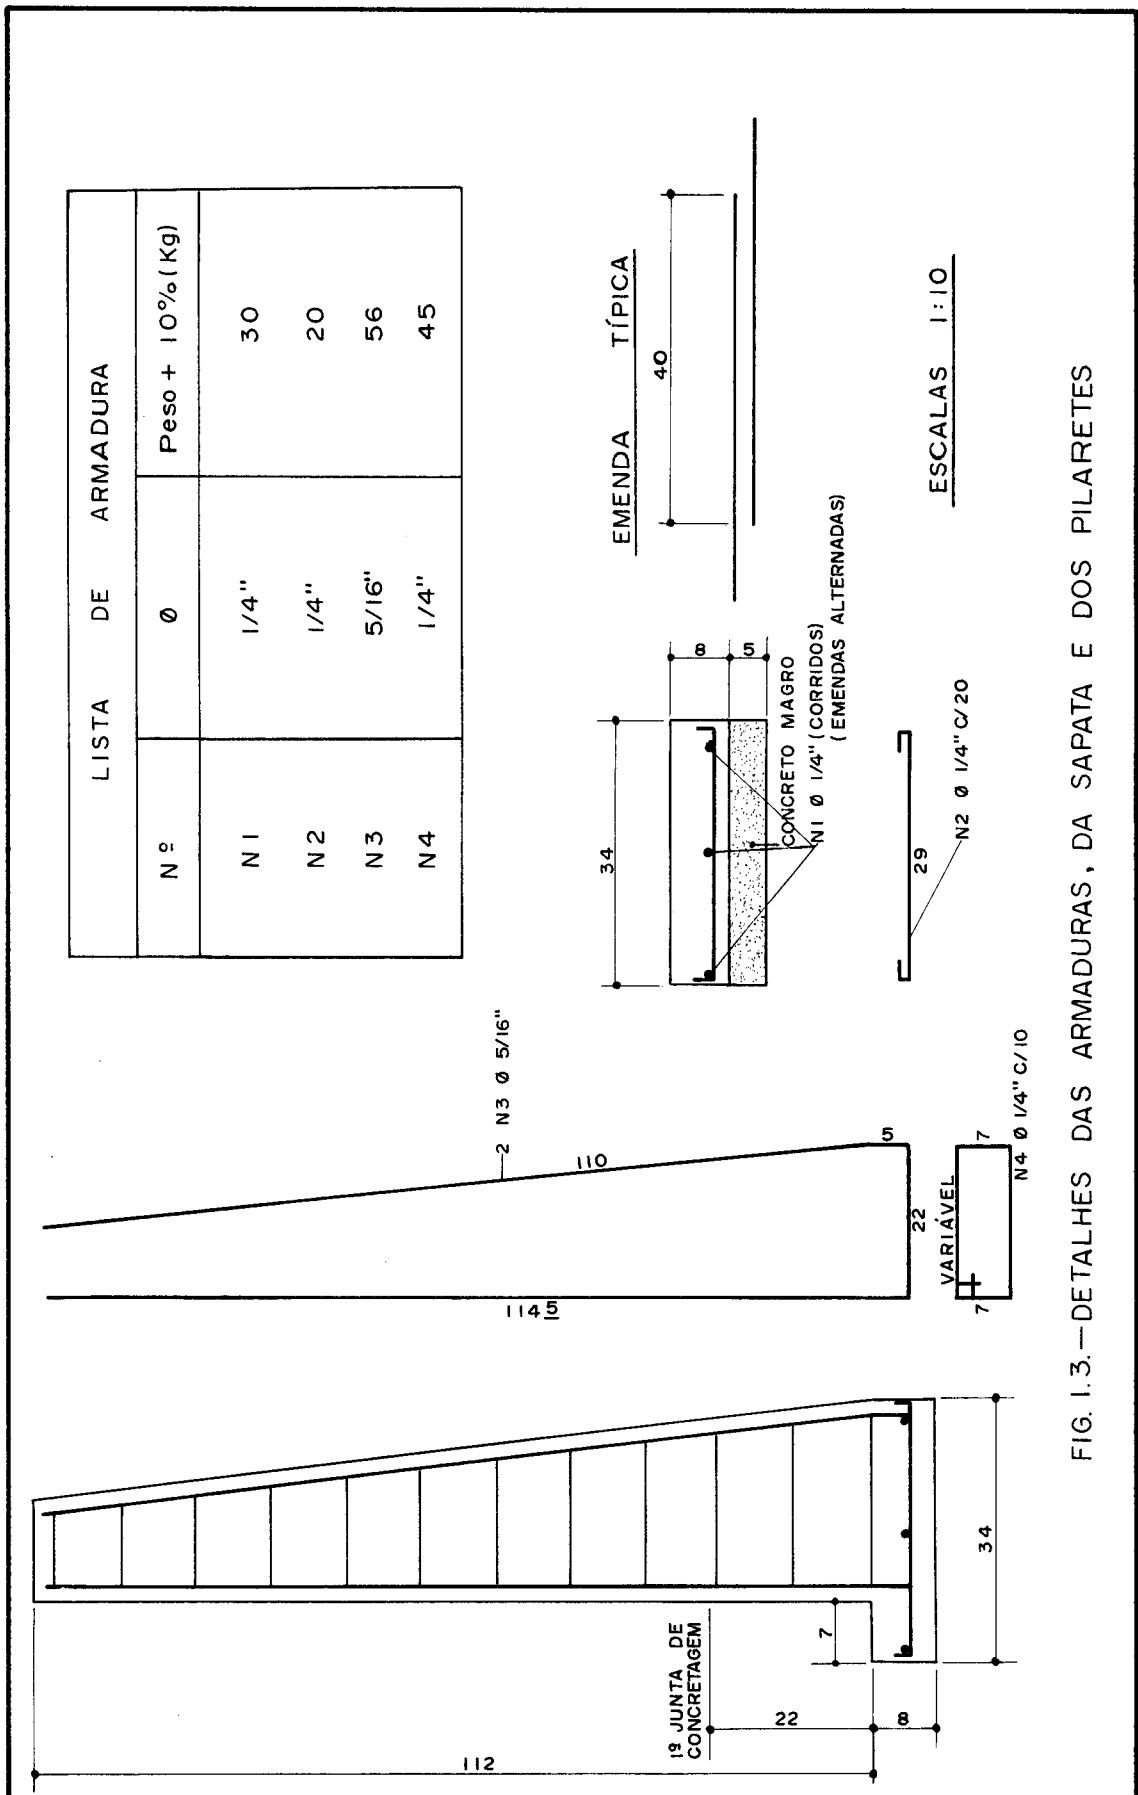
DETALHES DAS ARMADURAS, DA SAPATA E DOS PILARETES
